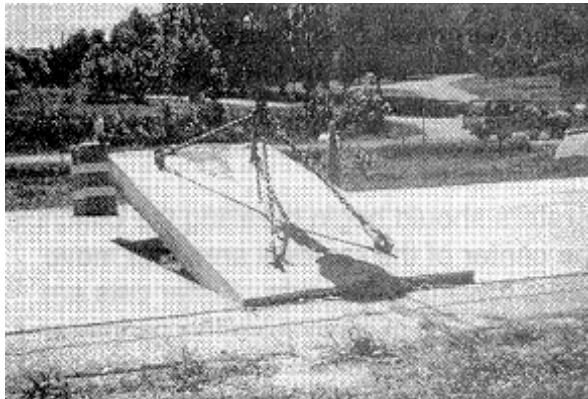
Levantamiento de losa de concreto hidráulico
